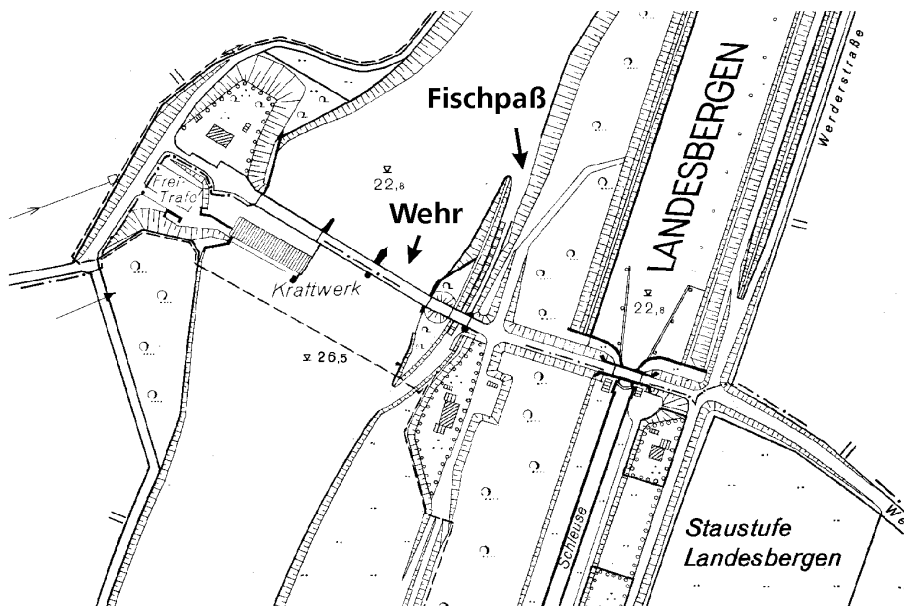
Lageplan der Wehranlage Landesbergen
